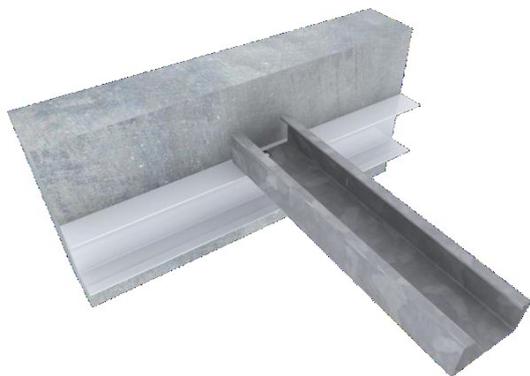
Fissaggio dell'accessorio su profilo perimetrale con vite - VINCOLO FISSO
